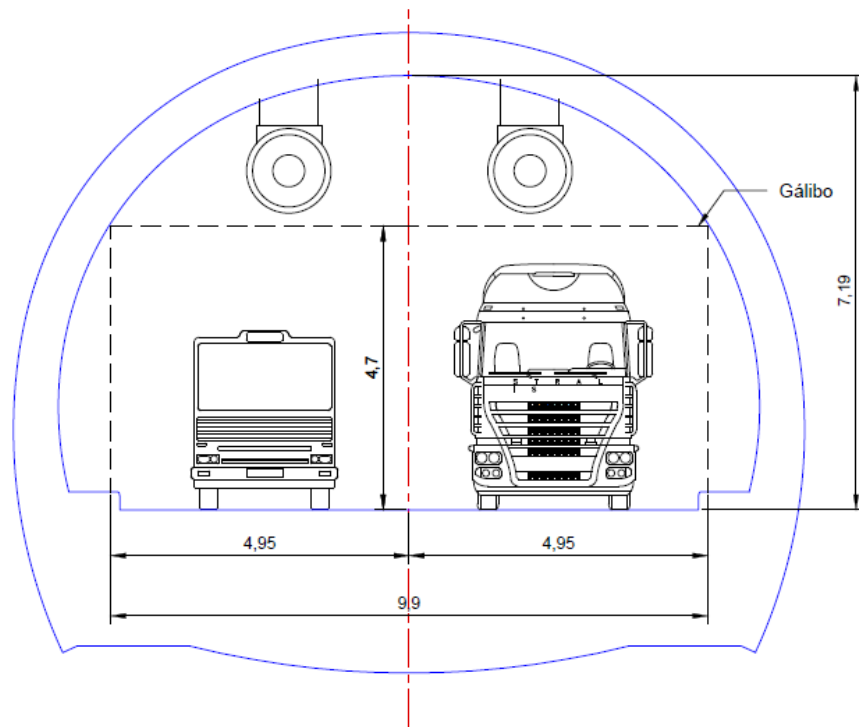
DETALLE DE BATERÍA DE VENTILACIÓN
